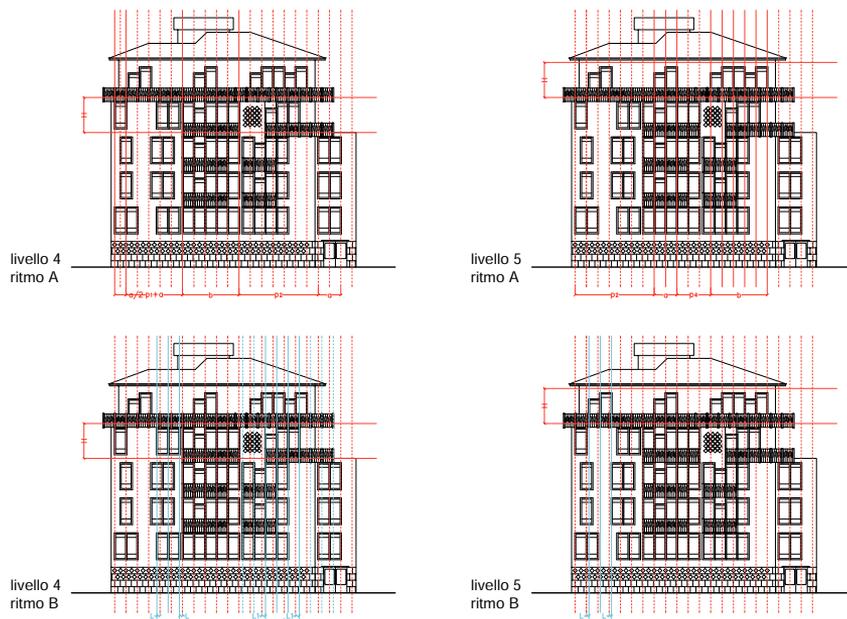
Casa alle Zattere, prospetto su Fondamenta delle Zattere, schematizzazione del sistema di proporzionamento ai vari livelli.
